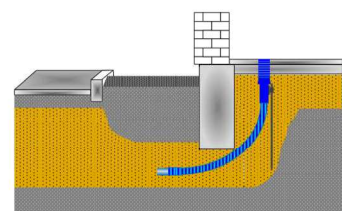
Gebäudeeinführungen Beispiele für Hauseinführungsvarianten
